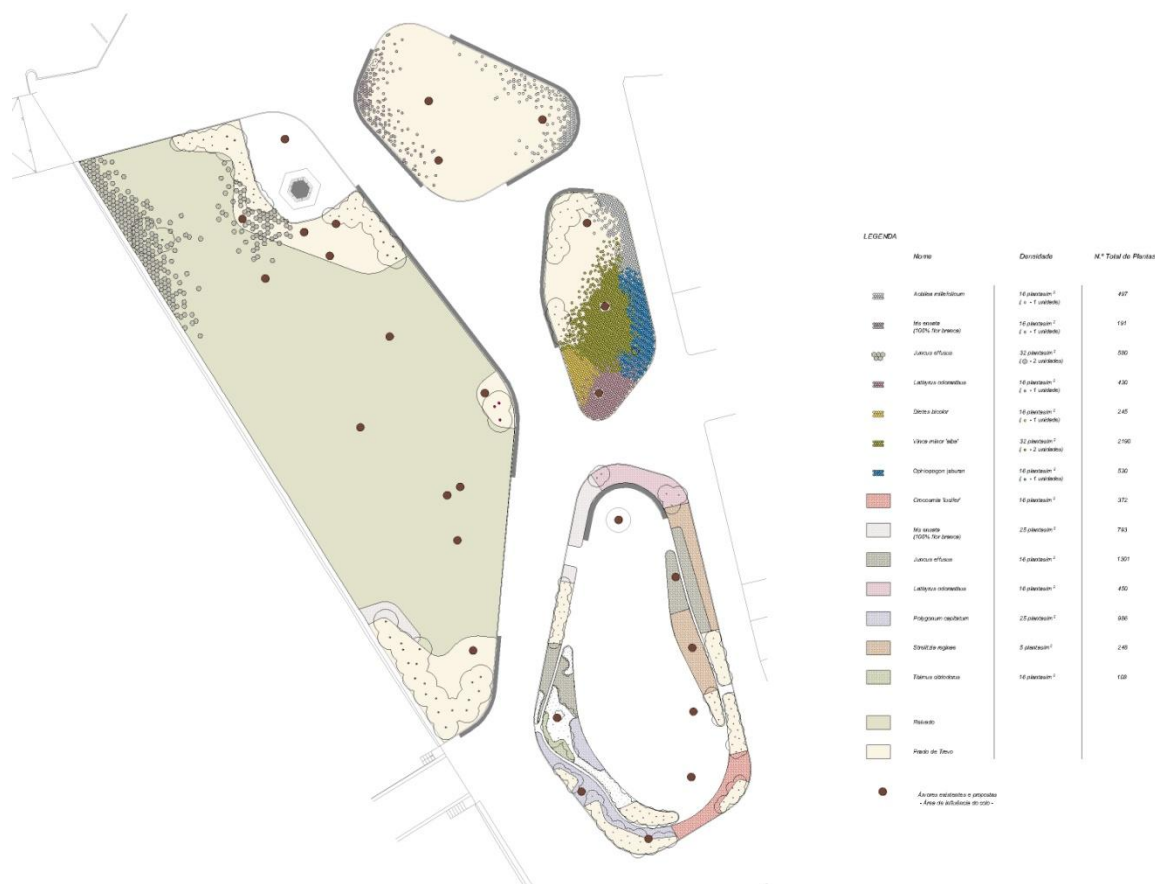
Plano de plantação (herbáceas) – zona do parque infantil
